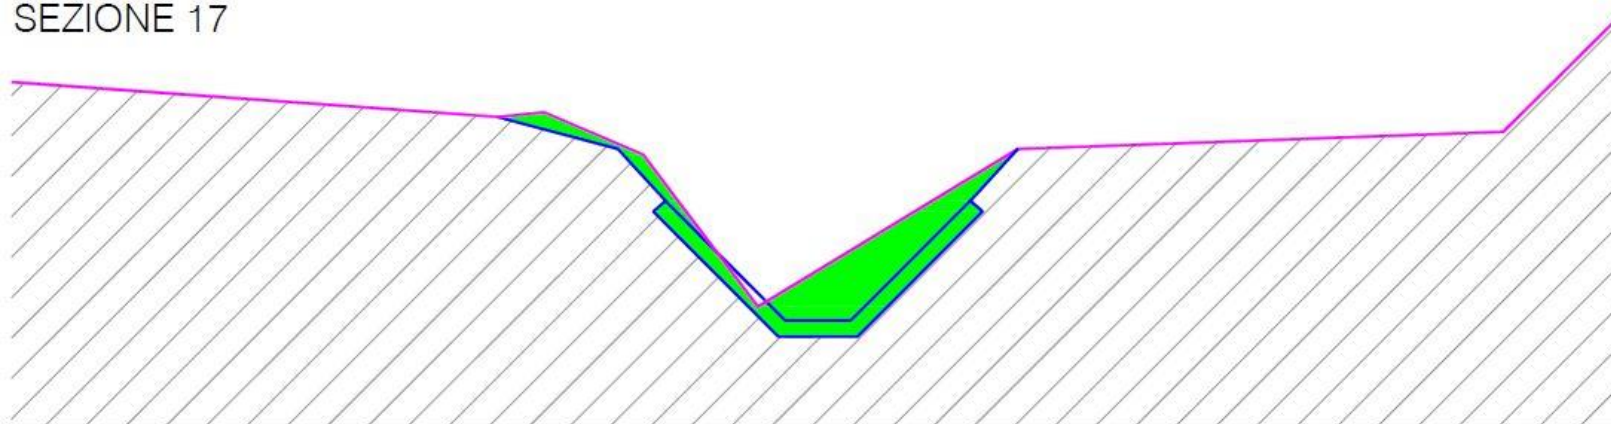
Prima sezione oggetto di intervento, sovrapposizione tra la sezione esistente e quella di progetto
